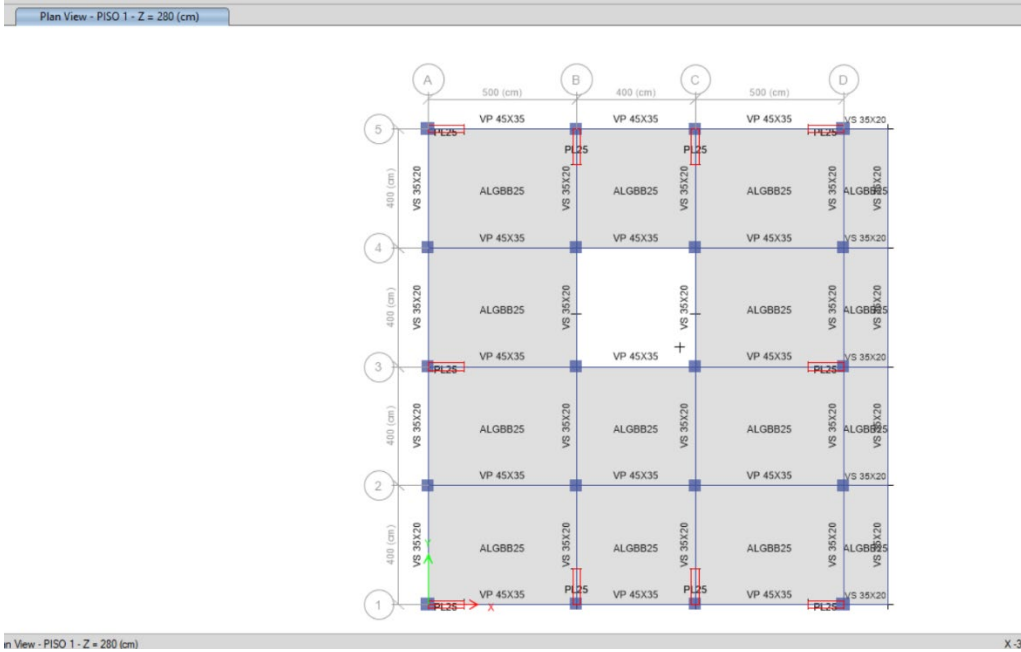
Plano en planta del piso 1 con todas las dimensiones de cada elemento
